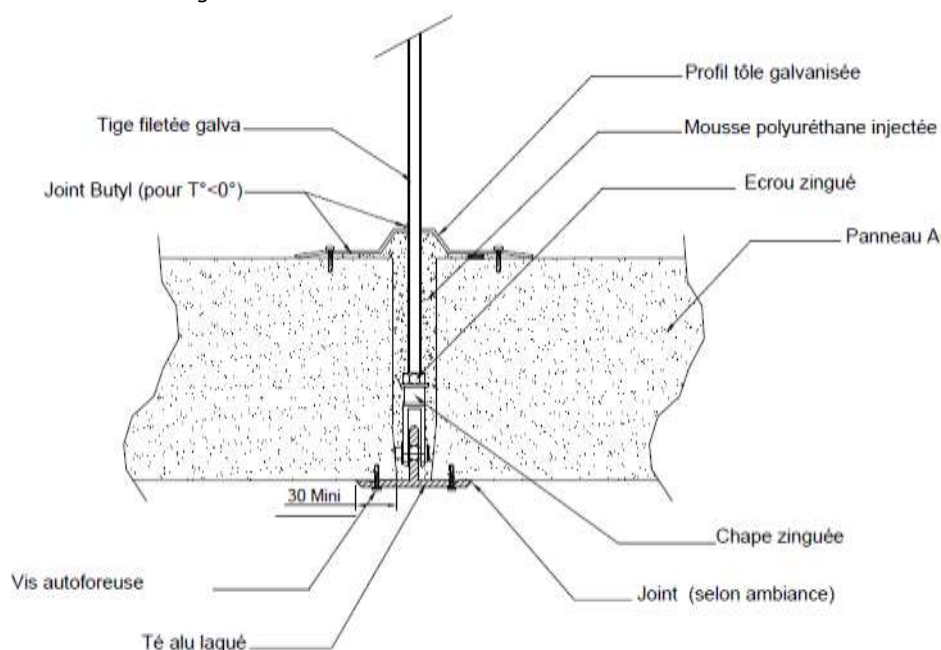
Exemple de la liaison (minimum 2 vis Ø 4,2 mm par largeur de panneau) entre le panneau et le Té et entre le couvre-joint et le panneau
